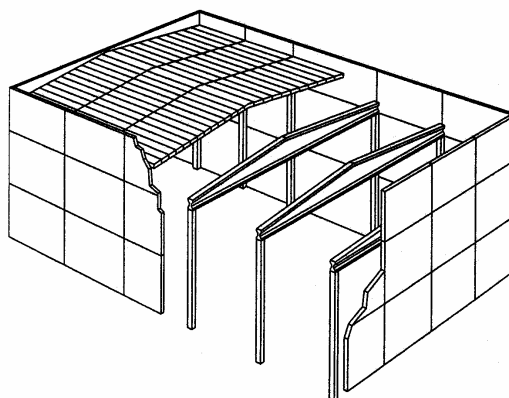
Trave aporticada com concreto celular ou lajes alveolares como elementos de cobertura.
